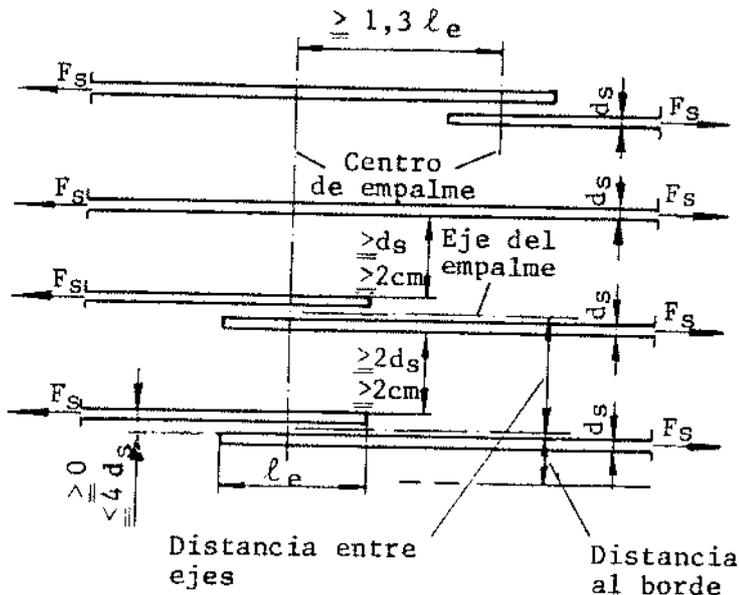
Desplazamiento longitudinal y separación transversal de las barras de la armadura en la zona de empalme.
